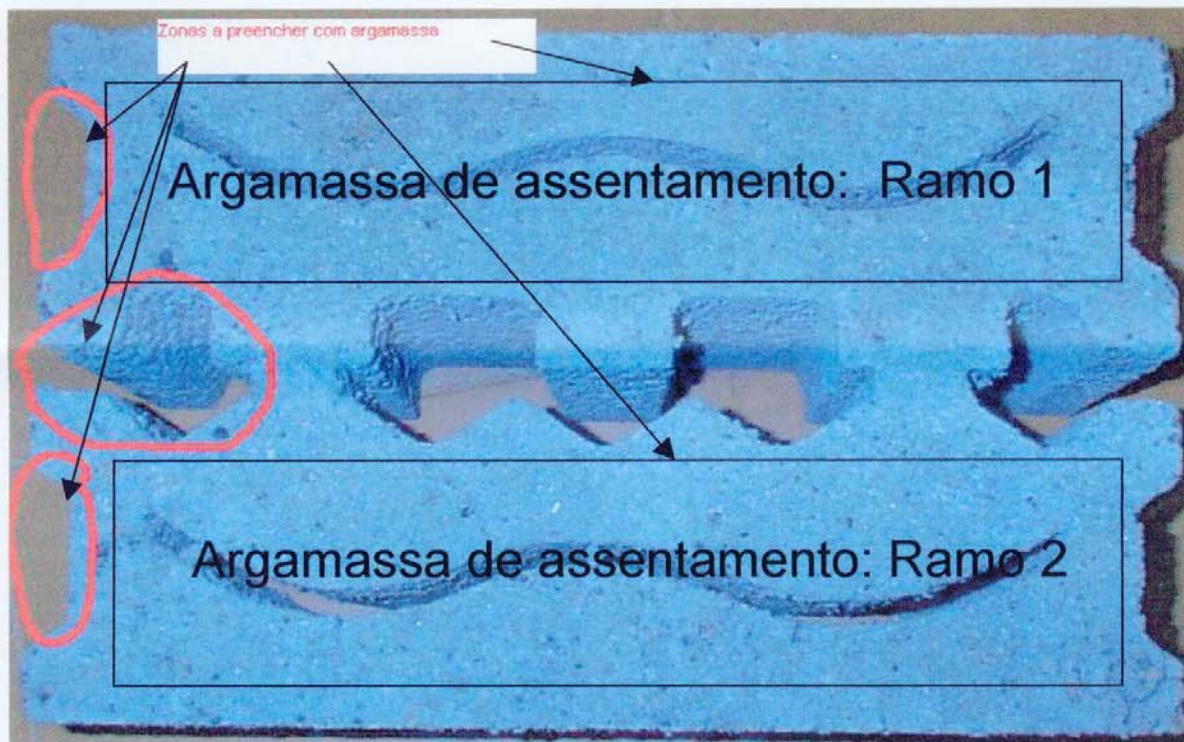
Ilustração do bloco de betão “Leca” constituínte da parede ensaiada
